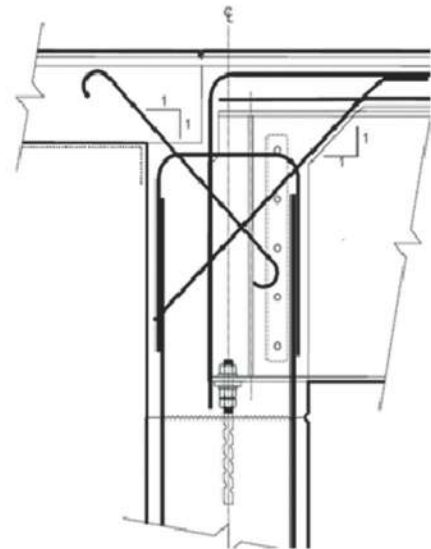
Характерное объединение сталежелезобетонных балок с телом интегрального устоя
